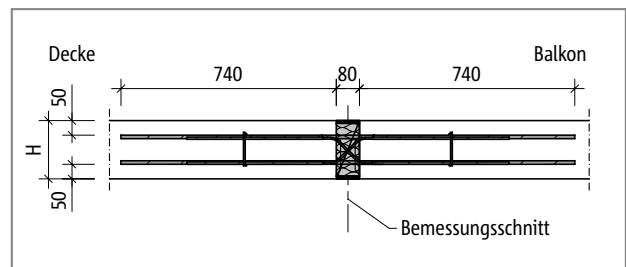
Schöck Isokorb® T Typ DL-CV2: statisches System
